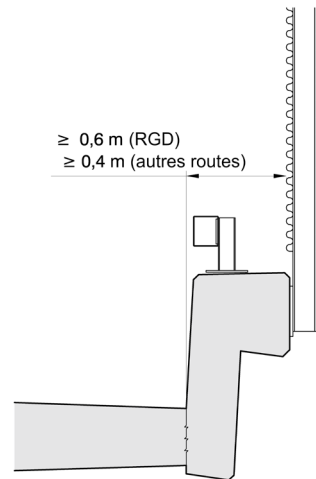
Paroi antibruit sur parapet système 93, GB 150'180 droit avec inclinaison maximale de 6%, sur un pont et avec une distance minimale entre la face antérieure du parapet et la paroi antibruit
